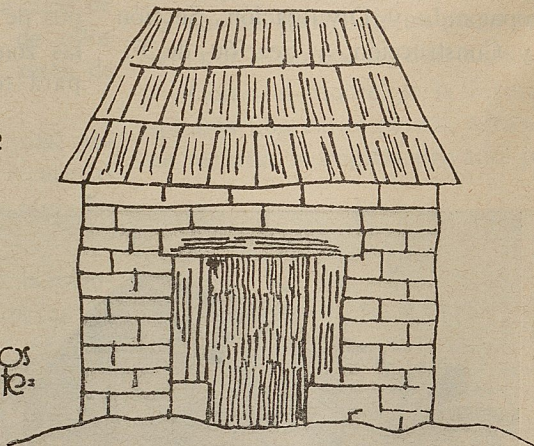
jacal con muros de adobe y techo de tejamanil.
